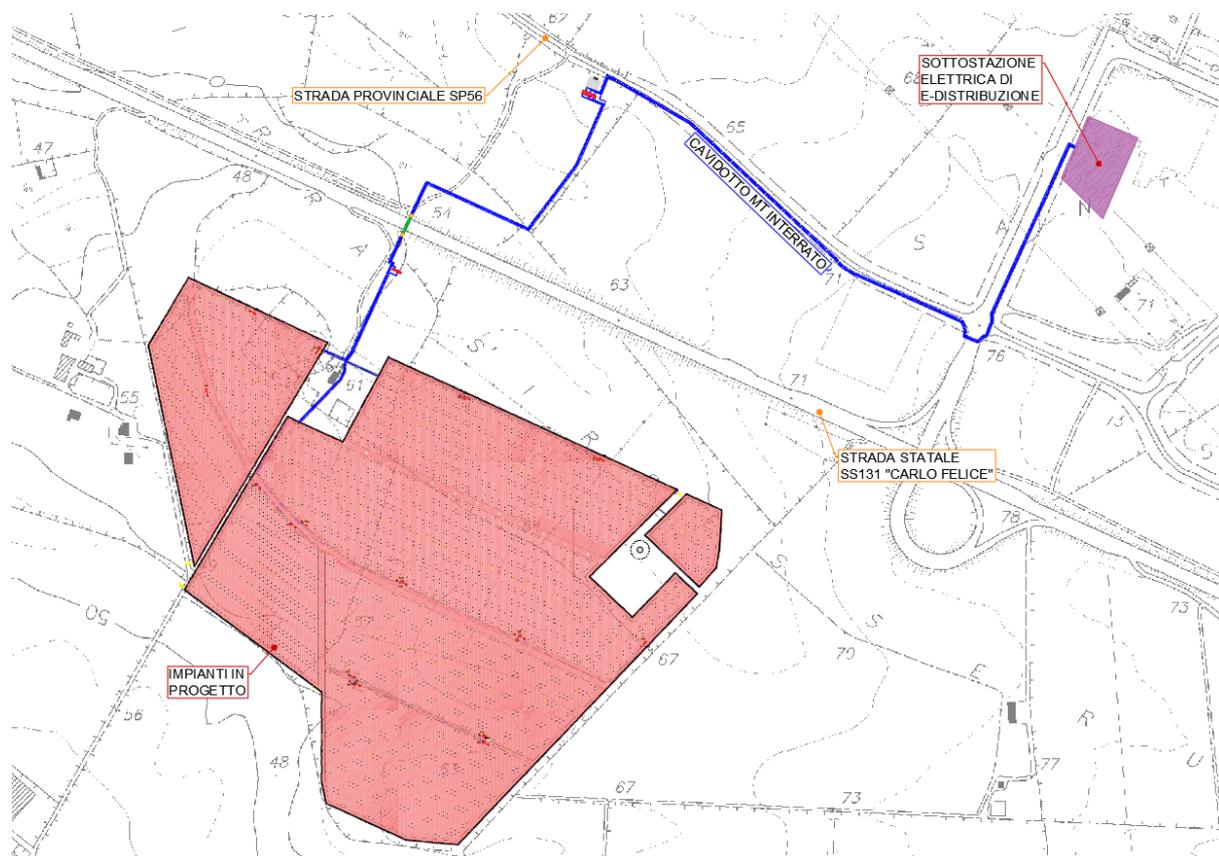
Planimetria cavidotti di connessione lotto 3
